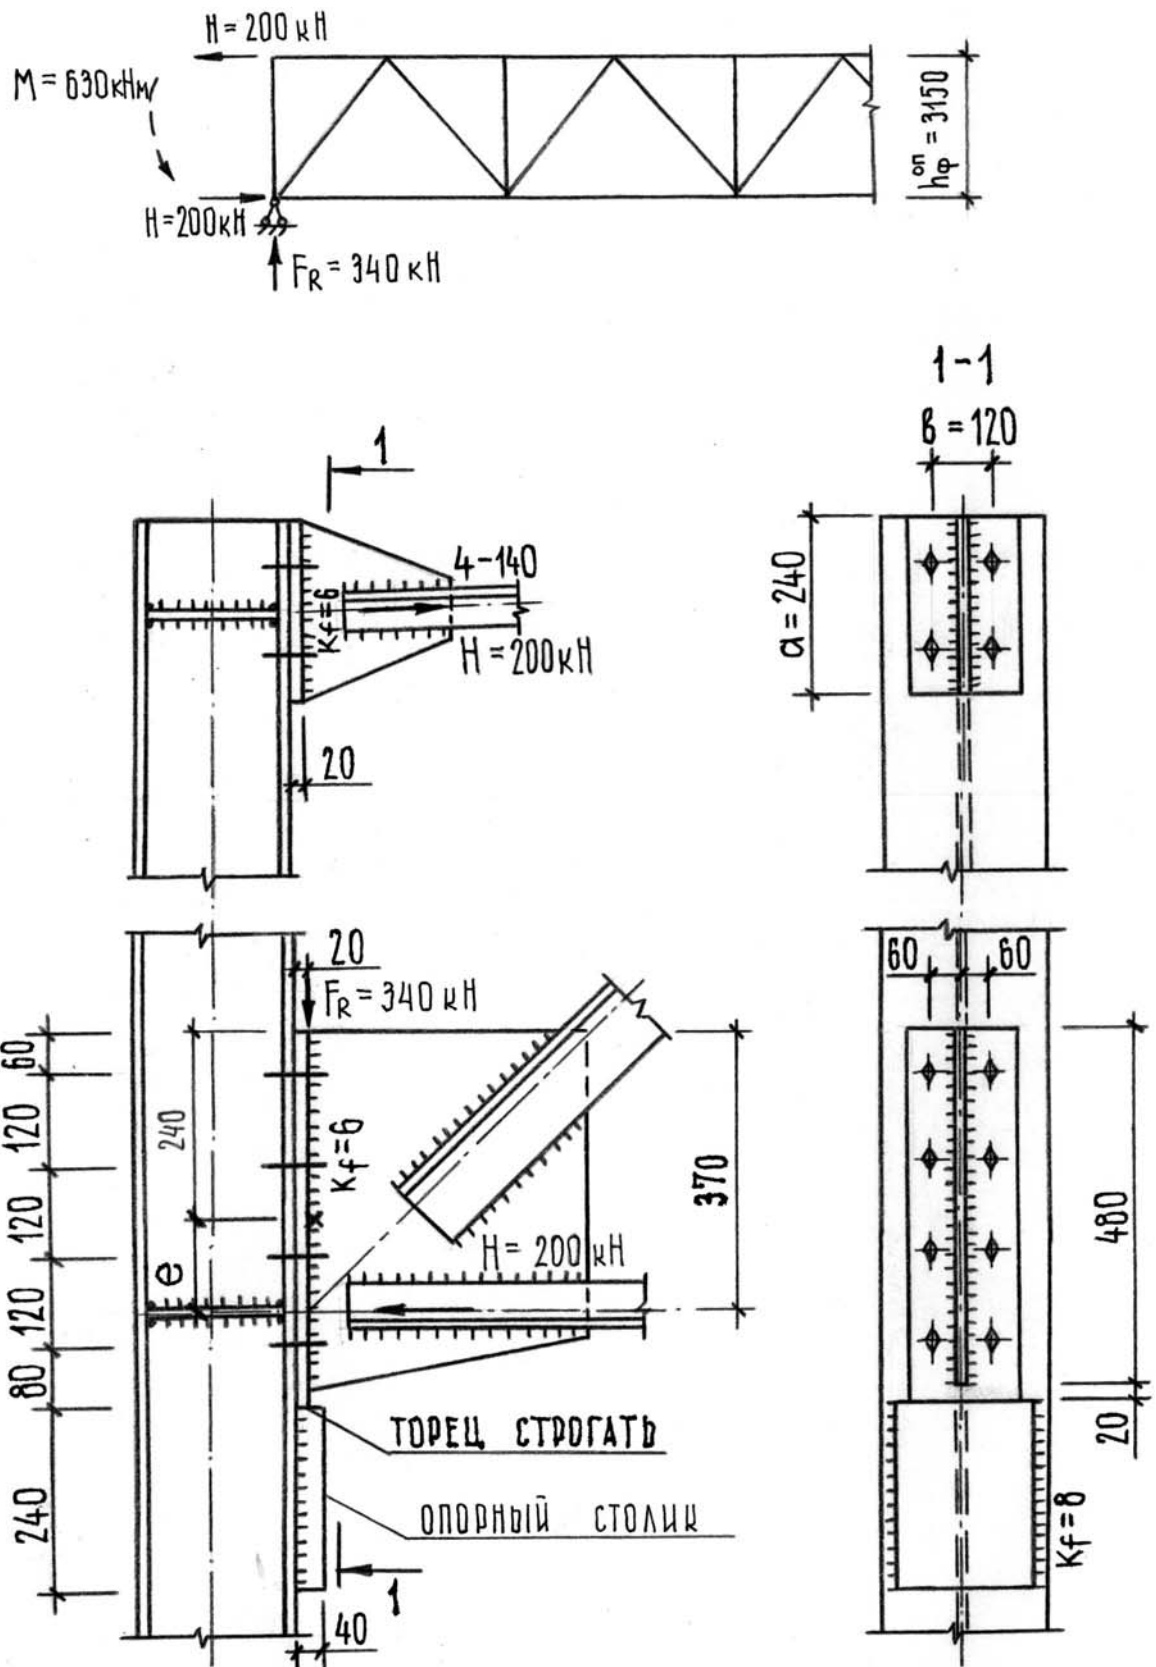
Опорный узел фермы из парных уголков (пример 3)
